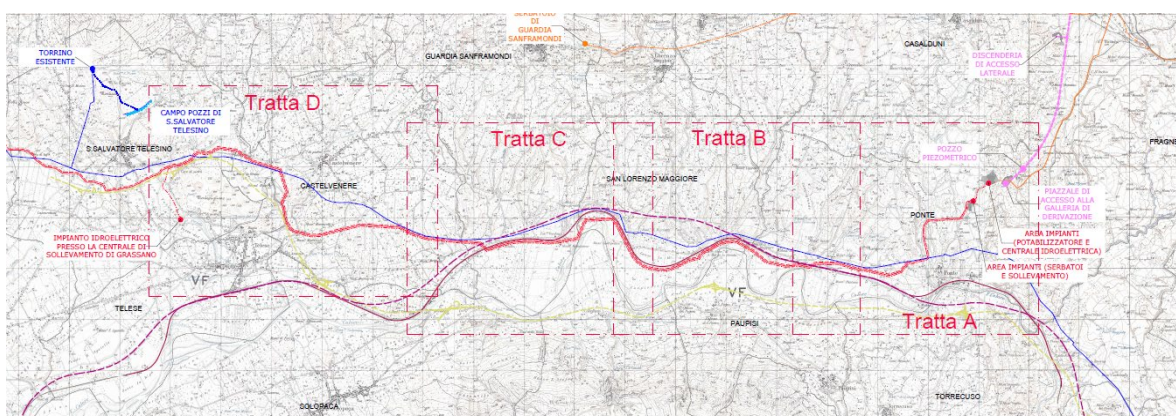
Planimetria Condotta irrigua (in rosso)
